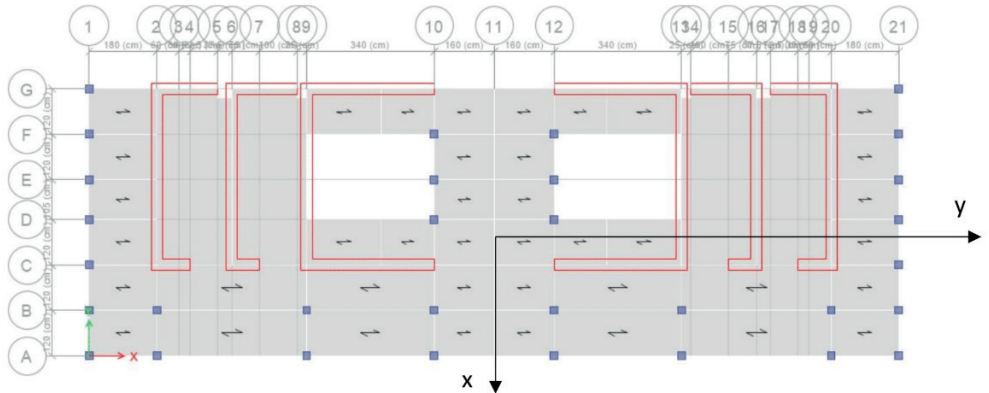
Planta tipo de los pisos 2 a 9 del edificio
